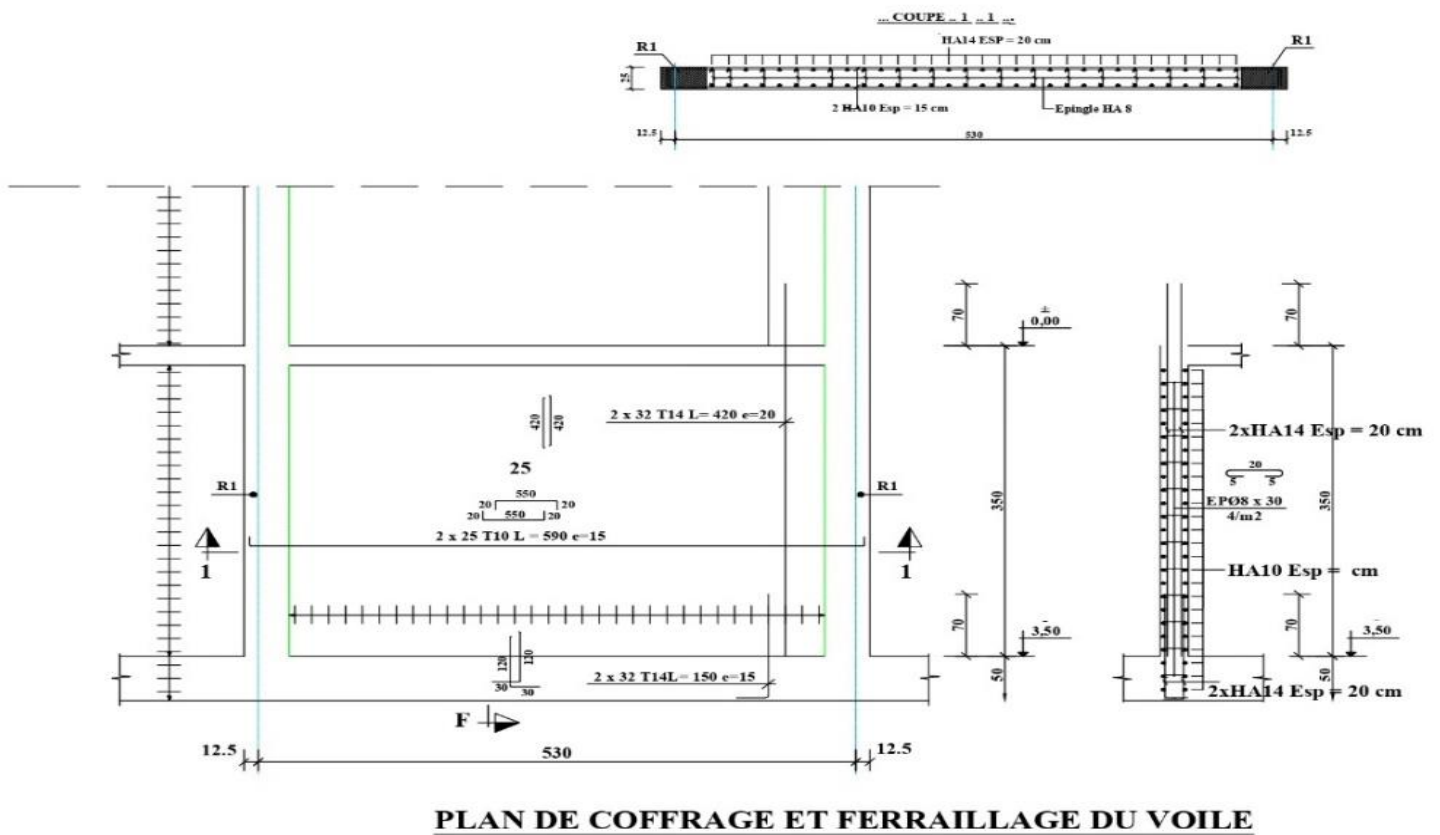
Plans de coffrage et Ferrailage du voile9 (Bloc1)
